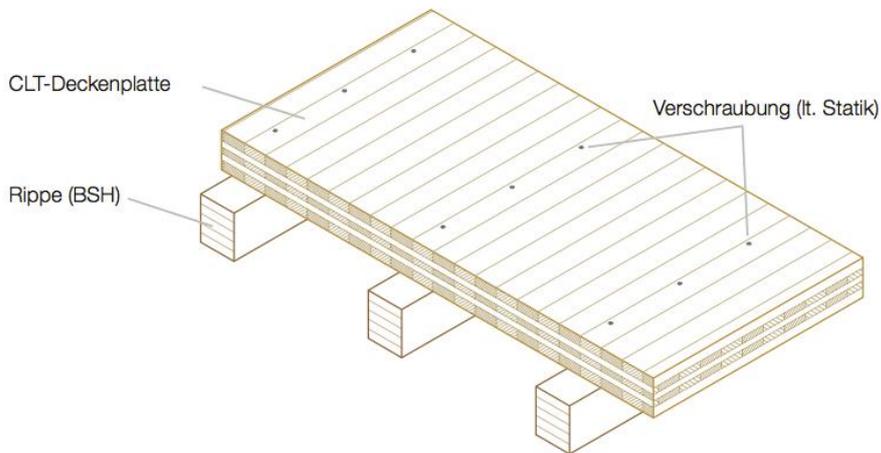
Rippendecke - Storaenso¹⁸⁹
